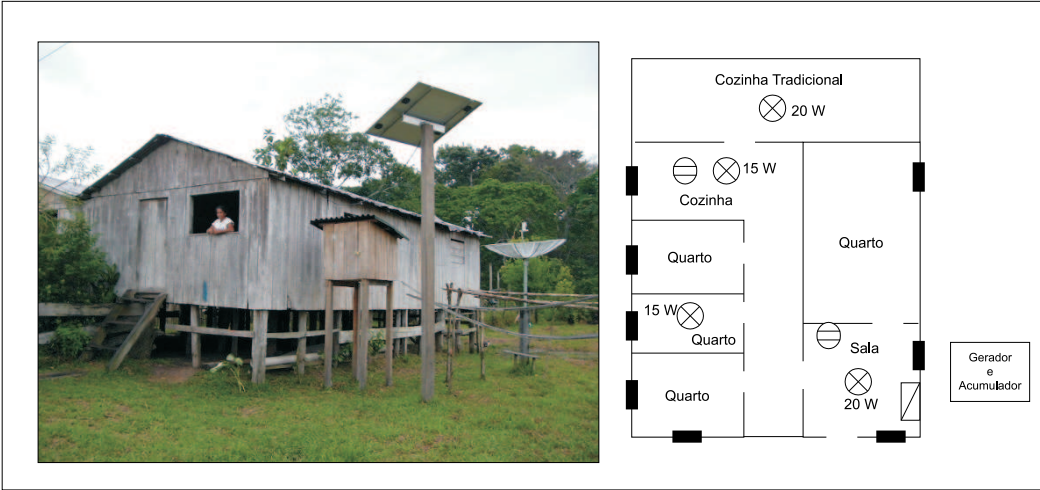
Vista externa do SFD15 e planta aproximada do domicílio.
